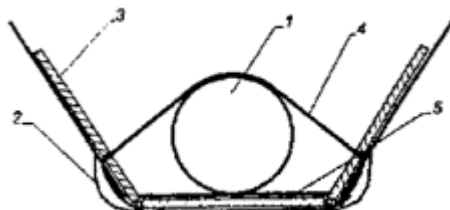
Железобетонный утяжелитель типа УБГ: 1 – трубопровод;
